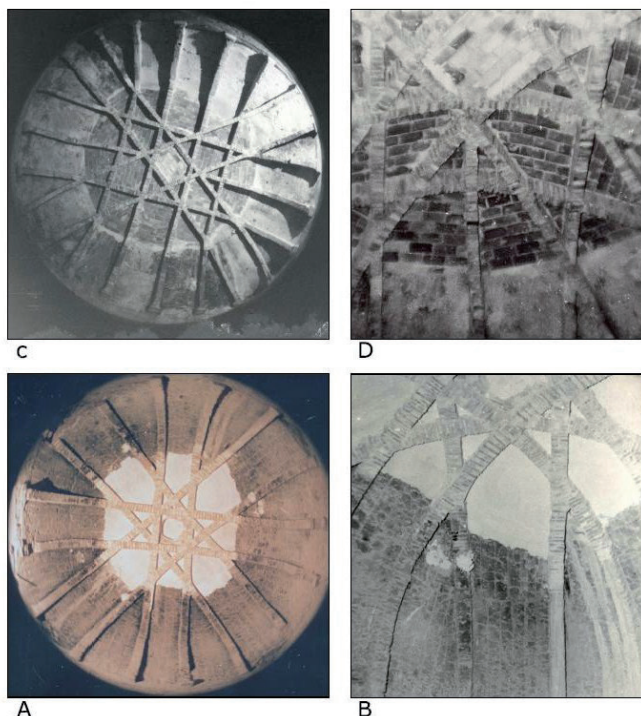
Fotografías posteriores a la reconstrucción de 1957: A y B: Bóveda 1, planta baja. C y D: Bóveda 2, planta primera.
